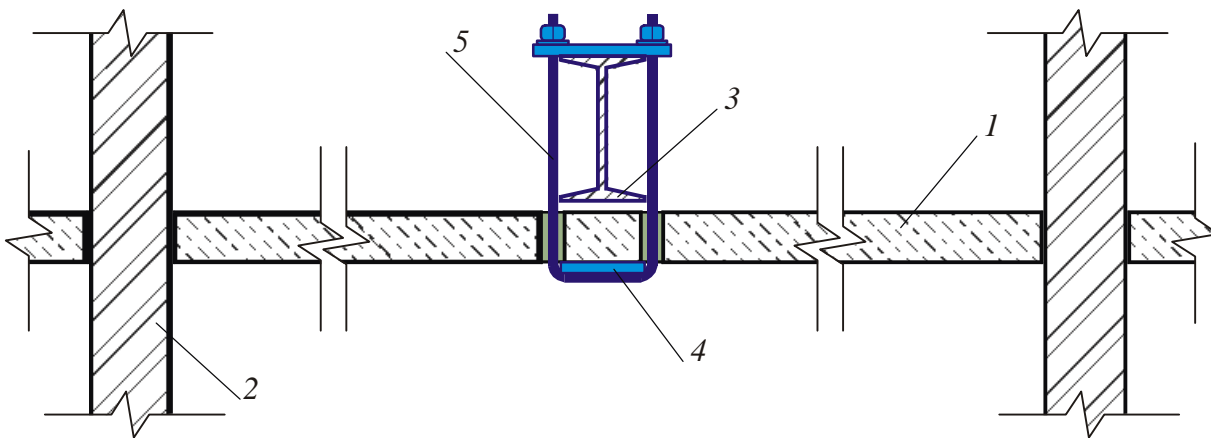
Устранение прогиба перекрытия подвешиванием к двутавровой балке:
